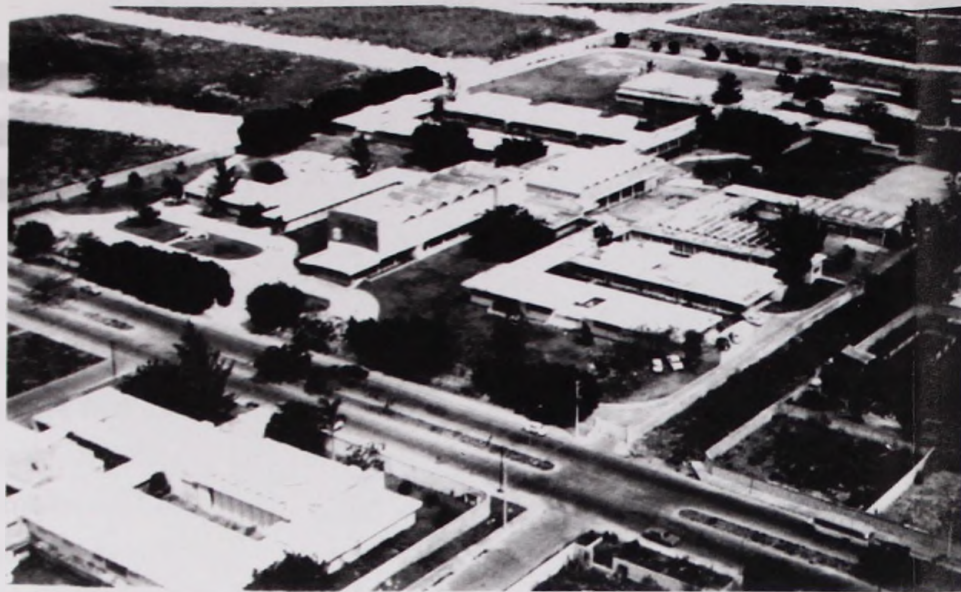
Vista de conjunto del estado original. En primer plano se aprecia el edificio de residencia de las religiosas y capilla.
